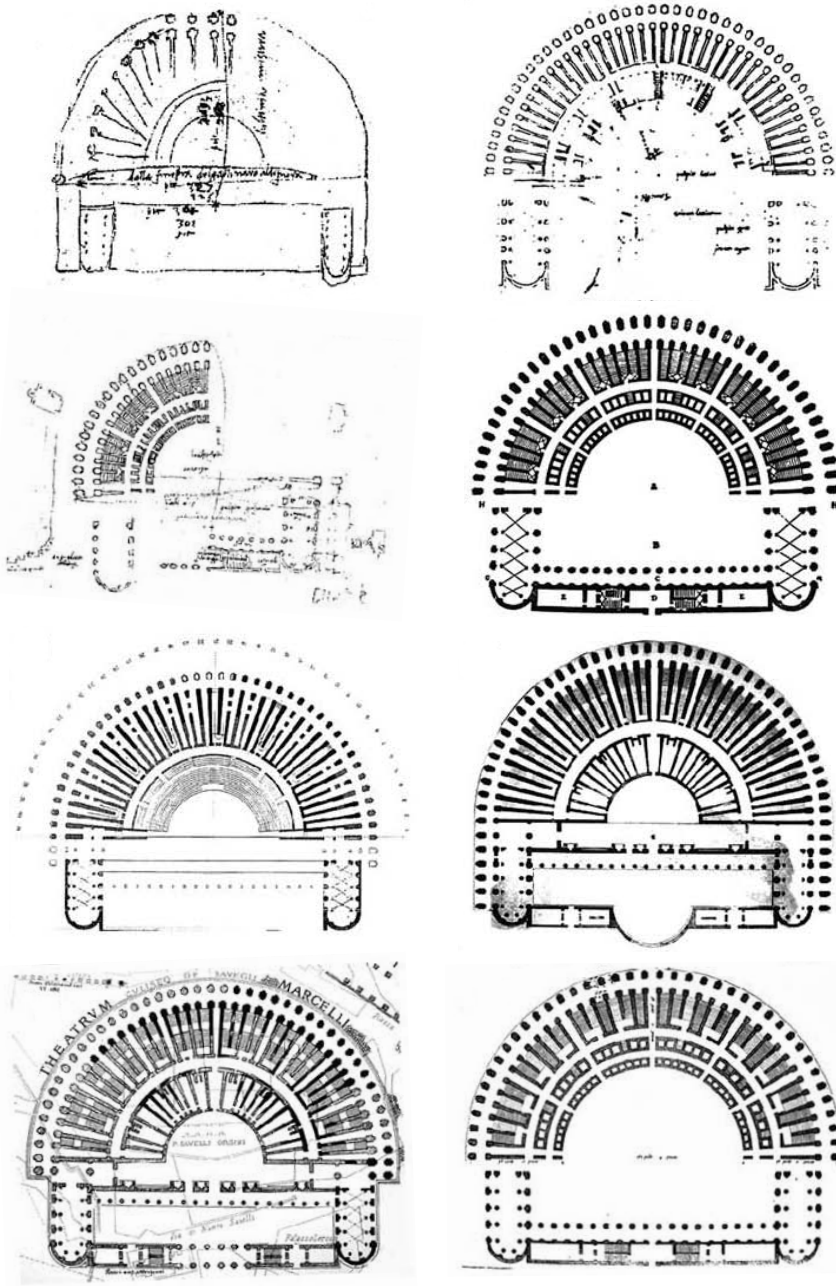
Teatro de Marcelo. A. Planta de B. Peruzzi; B. Planta de A y G. B. Da Sangallo; C. Planta de G. B. Da Sangallo; D. Planta de S. Serlio; E. Planta de A. Calza Bini; F. Planta de L. Canina; G. Planta de R. Lanciani; H. Planta de A. Desgodets.
